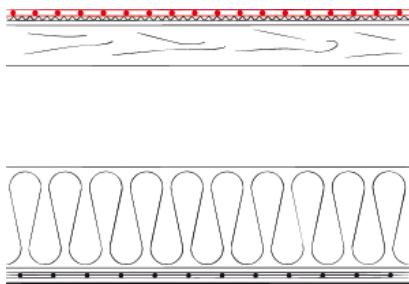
Bei einem Flachdach aus Holz bietet sich eine belüftete Dachkonstruktion an.
